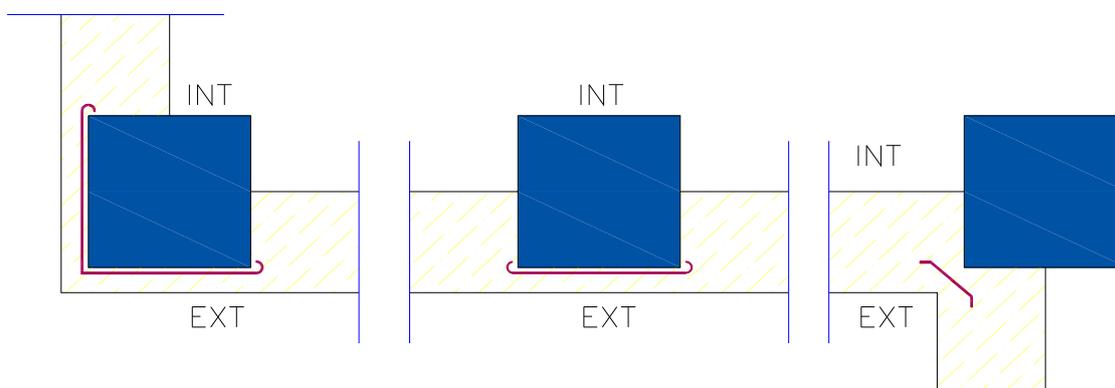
Ejemplo de encuentro de la fachada con los pilares
